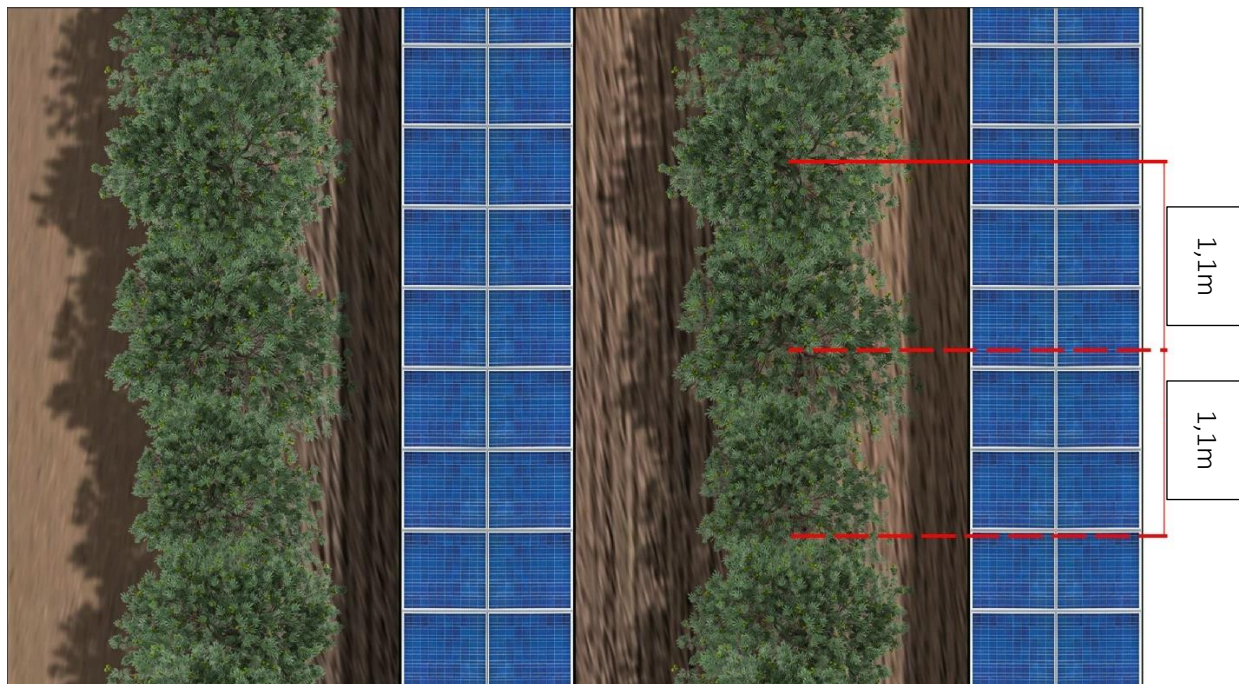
Tipologico – Vista Planimetrica dell’impianto Olivicolo.
